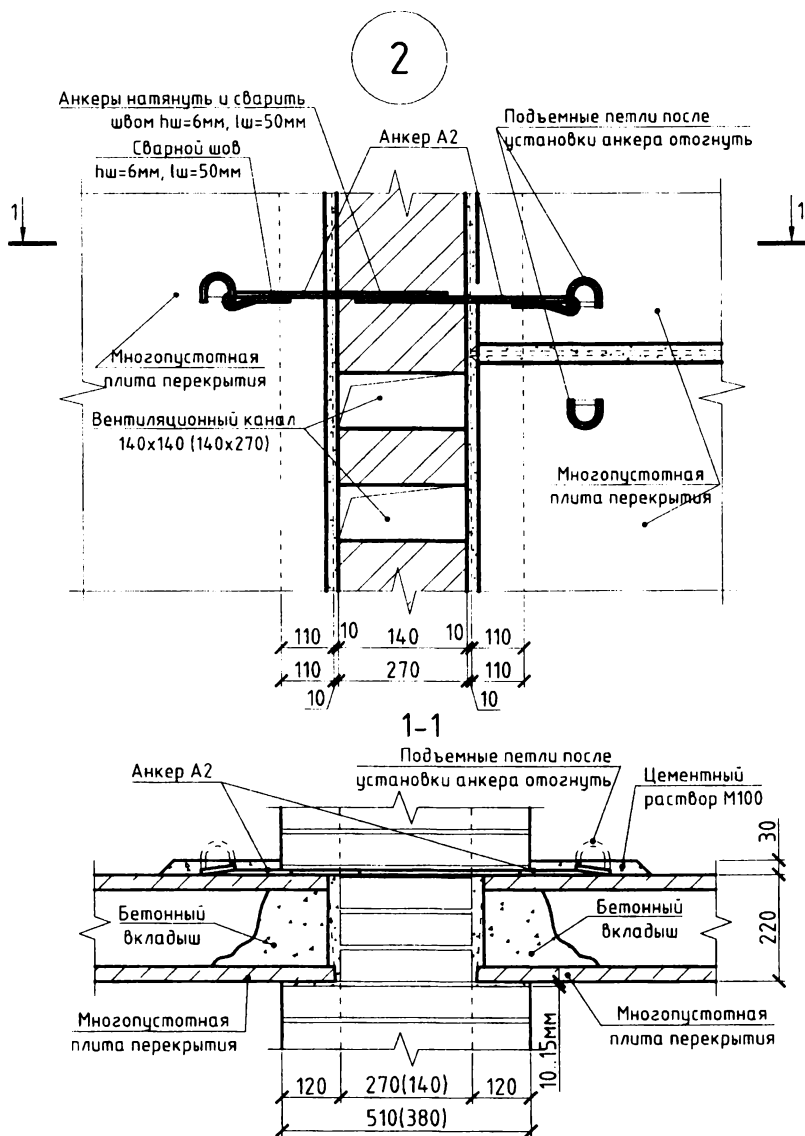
Узел опирания круглопустотной плиты перекрытия на внутреннюю несущую стену из мелкоштучных элементов (смотреть совместно с рисунком 12)
